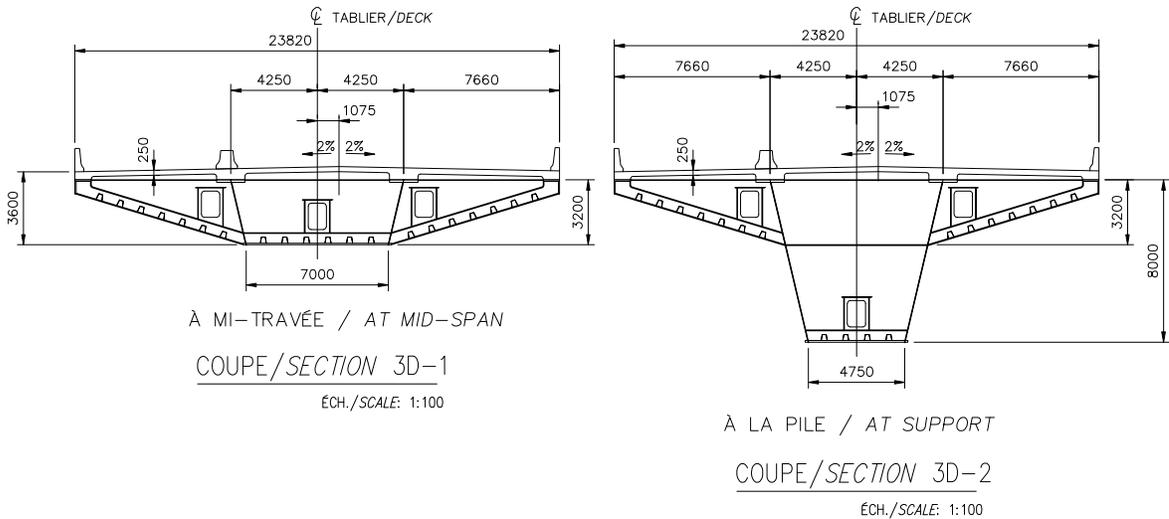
Coupes transversales – Pont en ossature mixte – monocoisson ouvert
